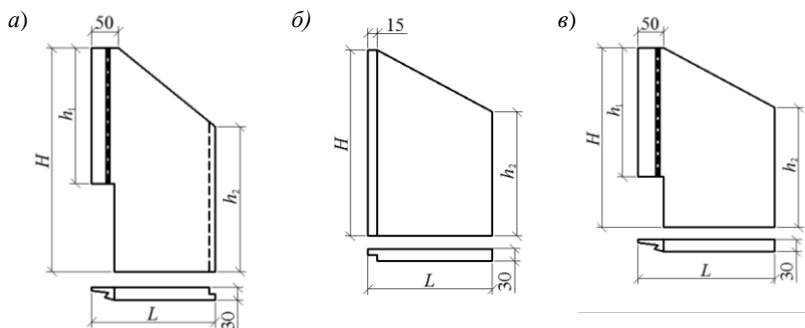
Откосные стенки для трубы водопропускной железобетонной прямоугольной сборной:
